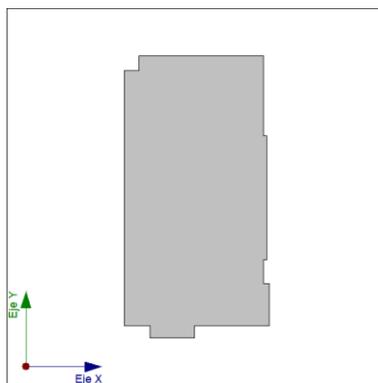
PROYECCIÓN EN PLANTA DE LA OBRA
